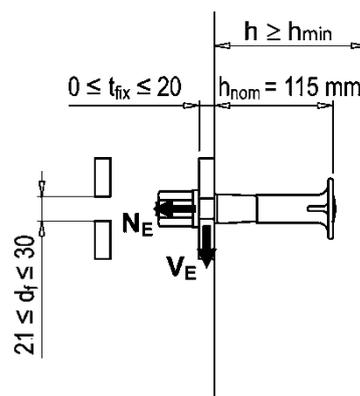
Einbauzustand Gesimsankerschraube Rd 20 mit montierter Stahlplatte
